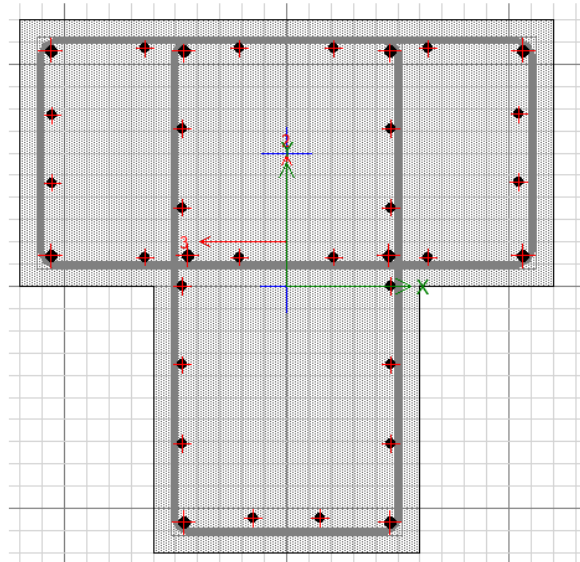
Columna en T 1.00x1.00x0.5m postensado.
